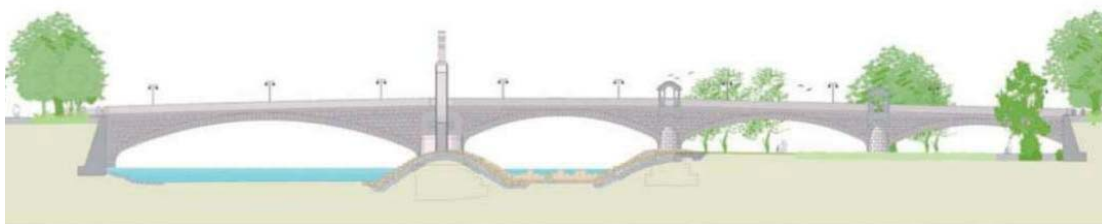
Detalle. Sección proyecto final «Isarplan BA5». Puente Wittelsbacher
